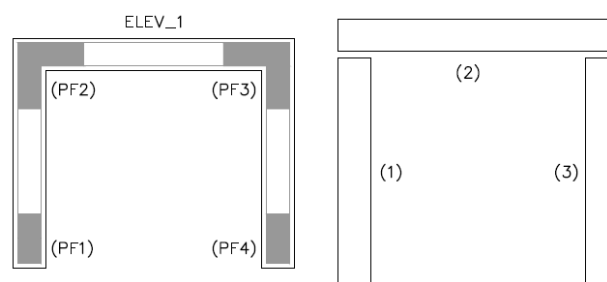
Localização dos pilares fictícios e divisão do núcleo de elevador em paredes simples
